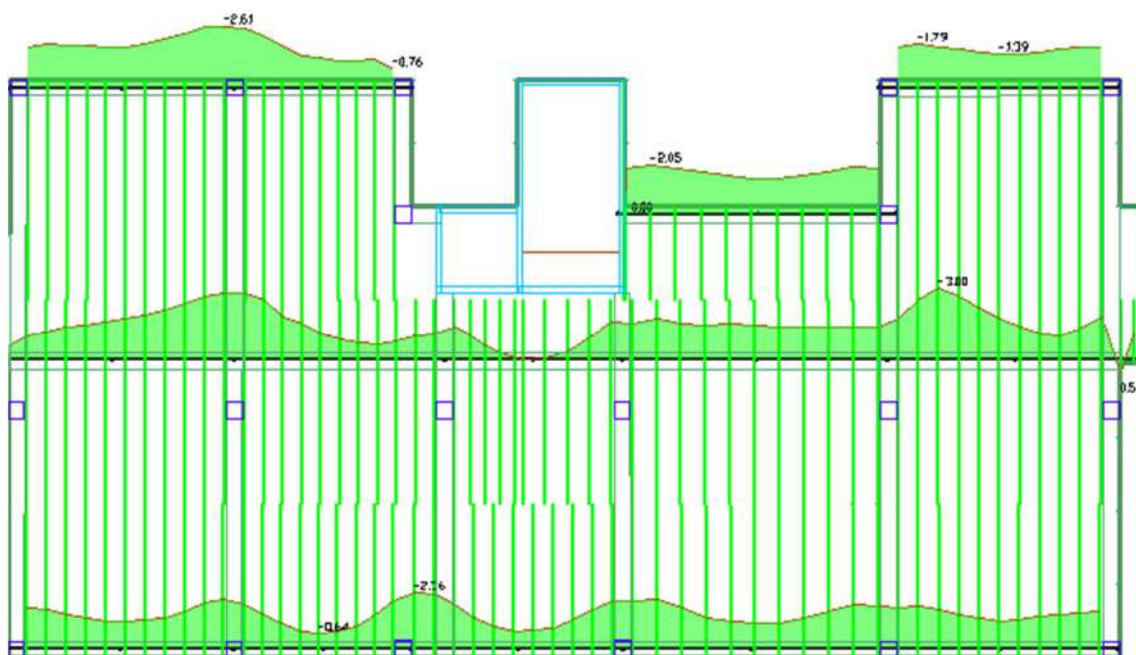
Tensiones en la fibra superior en estado de servicio en losa del Modelo N°5. Líneas de soporte horizontal. Fuente: Elaboración propia
